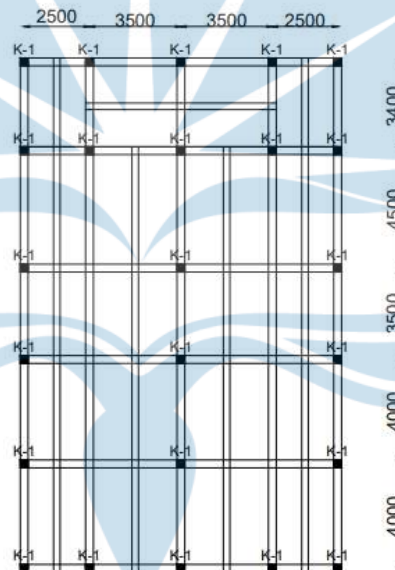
14 Layout Denah Balok Induk Unit 2
